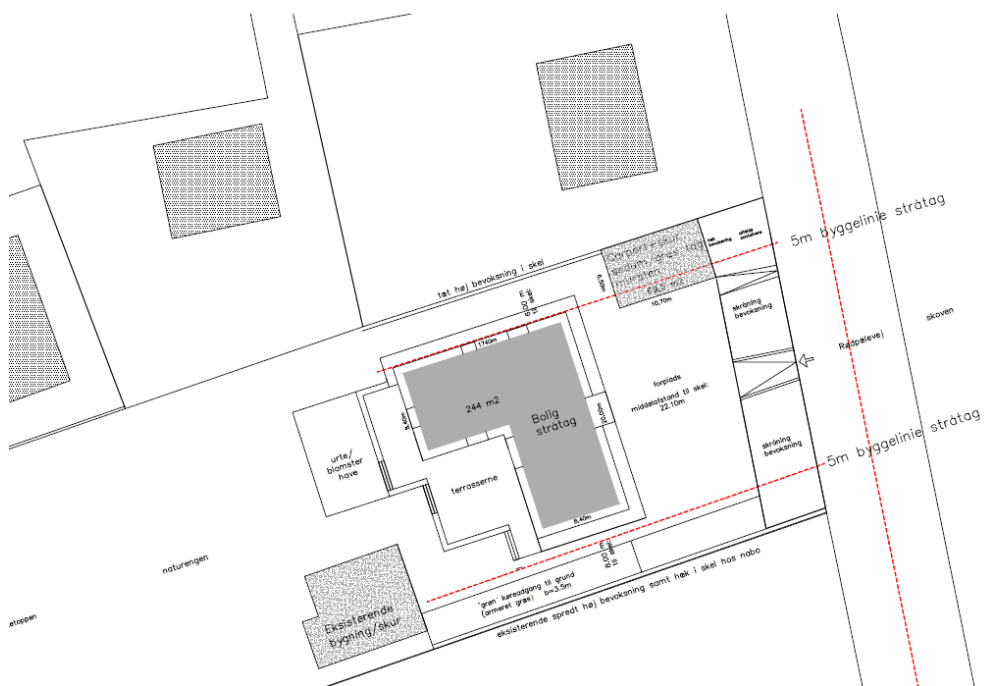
Situationsplanen viser omfang og placering af nyt enfamiliehus, garage og eksisterende/bevaret udhus.
